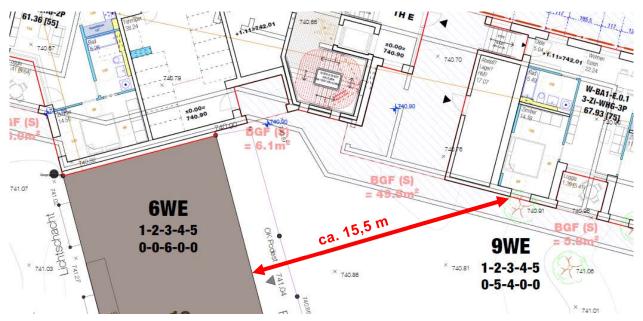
Ausschnitt Grundriss Erdgeschoss Neubau, Bauabschnitt 1, Quelle: wolf.sedat architekten
